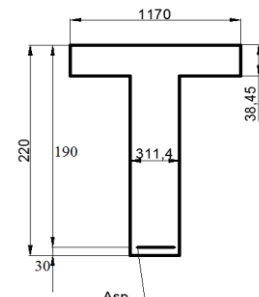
Поперечное сечение многопустотной плиты для расчета по I группе предельных состояний
